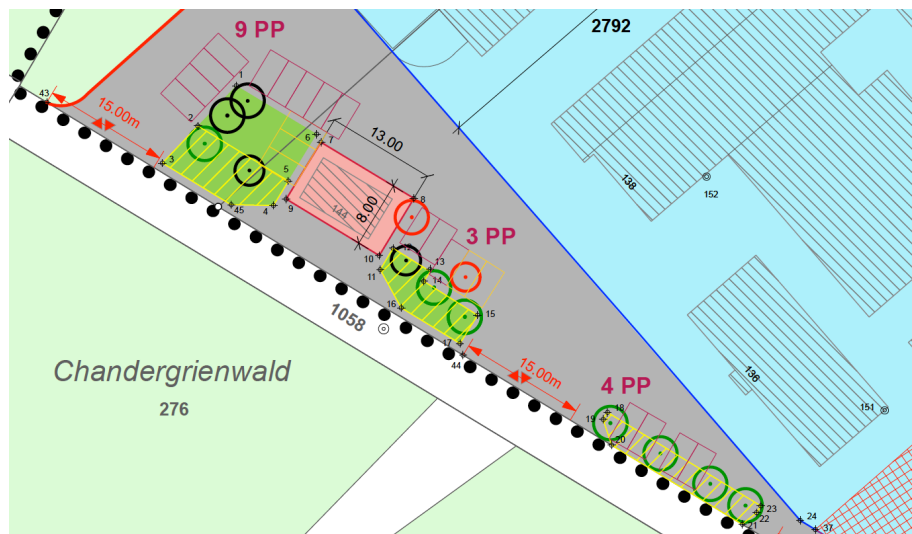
Erschliessung und Aussenraumgestaltung mit Grünbereich und Bäumen im Bereich der Tierkörpersammelstelle;
